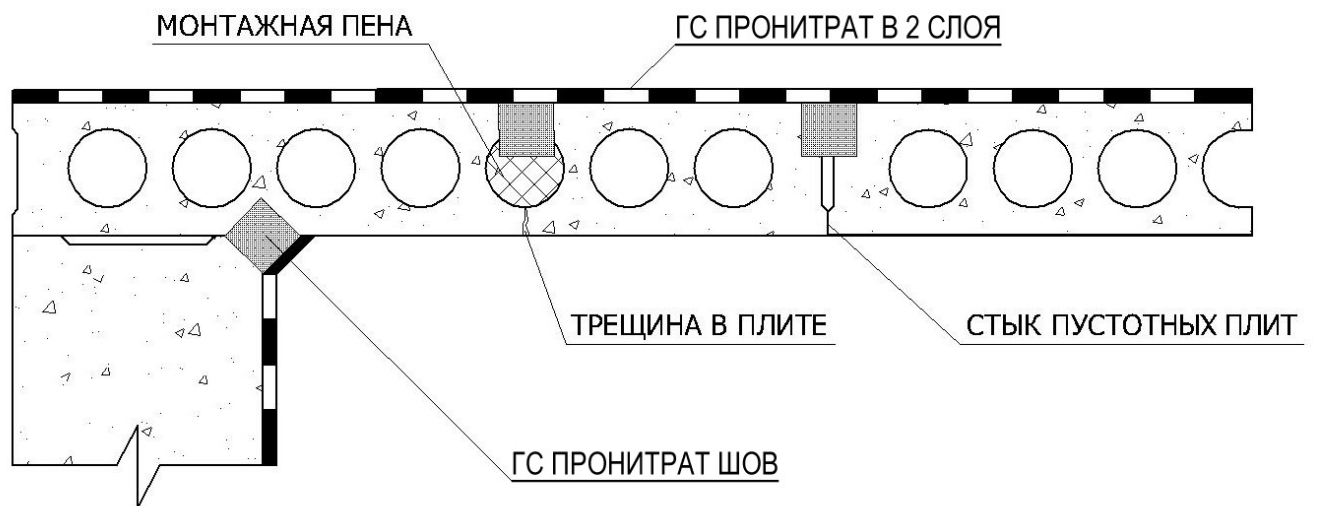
Устройство гидроизоляции существующей конструкции из пустотных плит перекрытия
